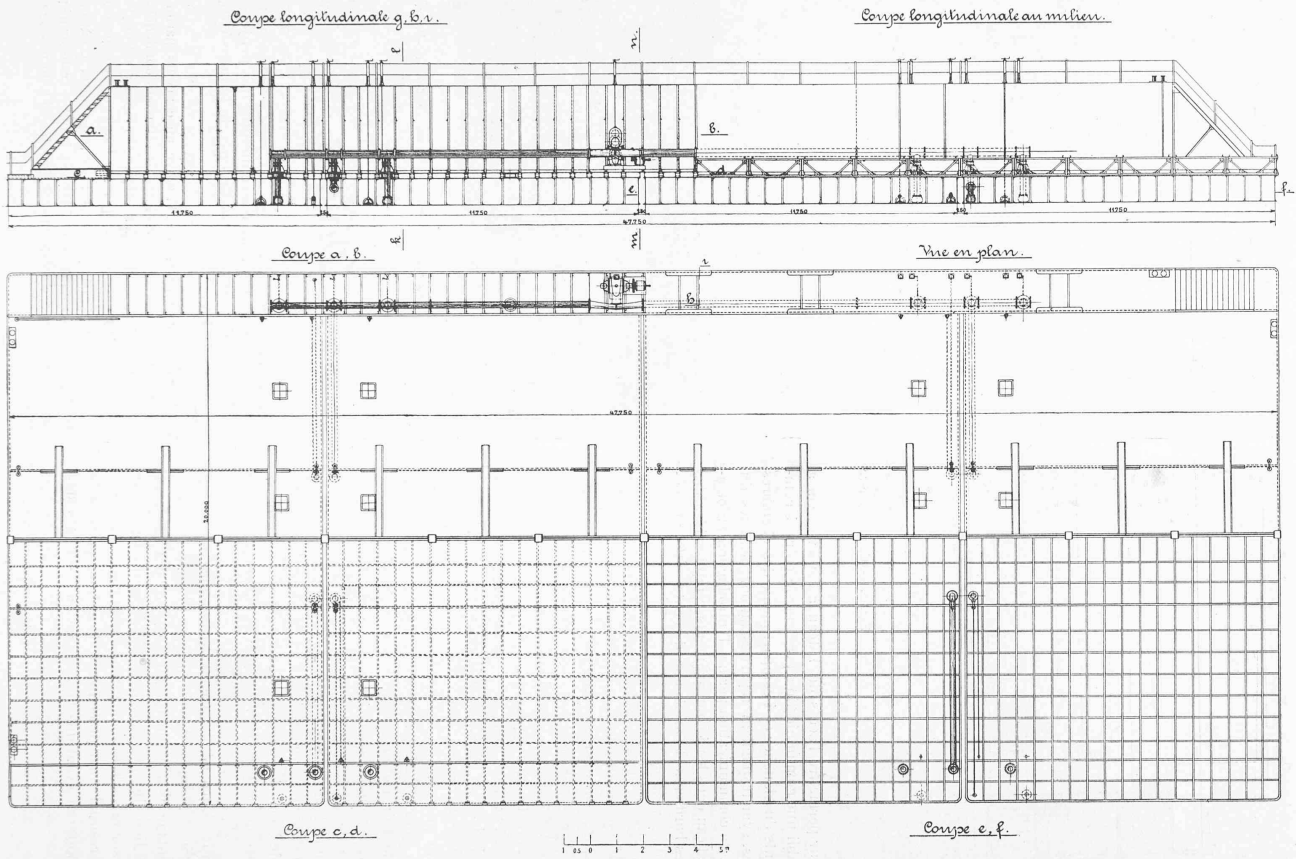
et 3. — Plan et coupe longitudinale du dock flottant d'Ouchy.
